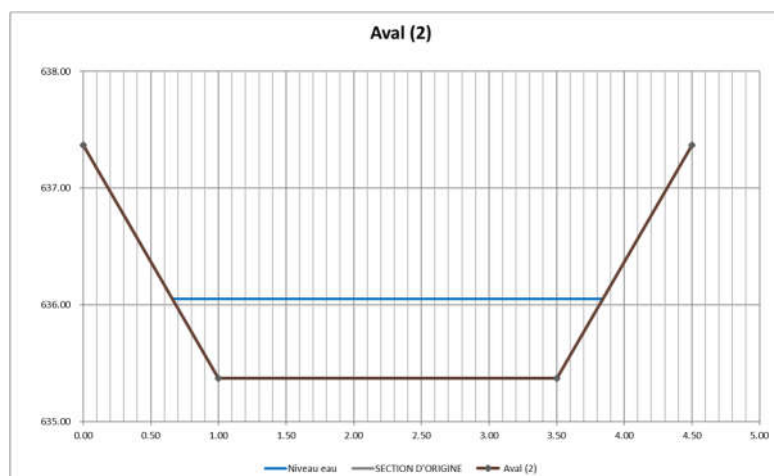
section type du coursier : hauteur = 2m, largeur en pied = 2.5 m
